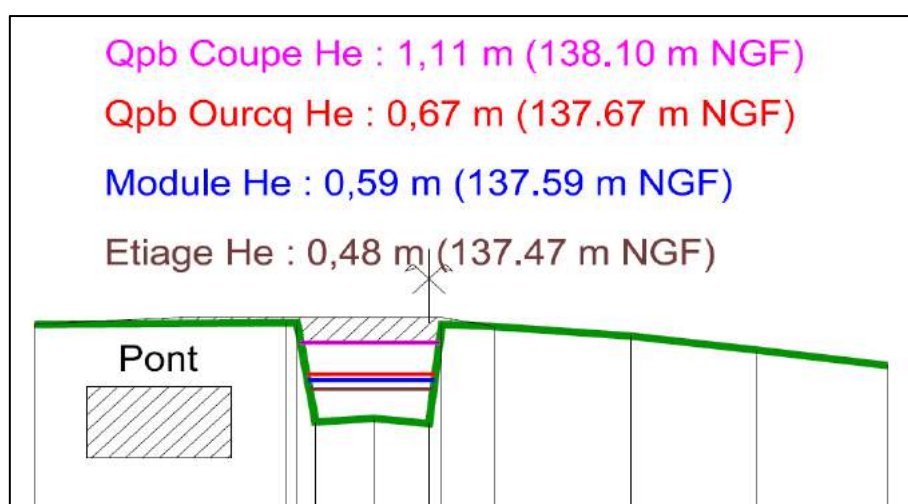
Profils en travers PT34 (au droit du pont du Ru de Coupé)
